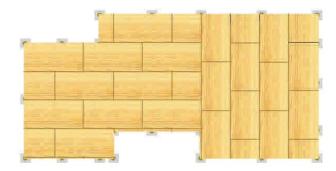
13: El plano de planta de construcción debe especificar la disposición de los tableros estructurales: contrachapado fenólico (terciado estructural) o de hebras orientadas (OSB).
